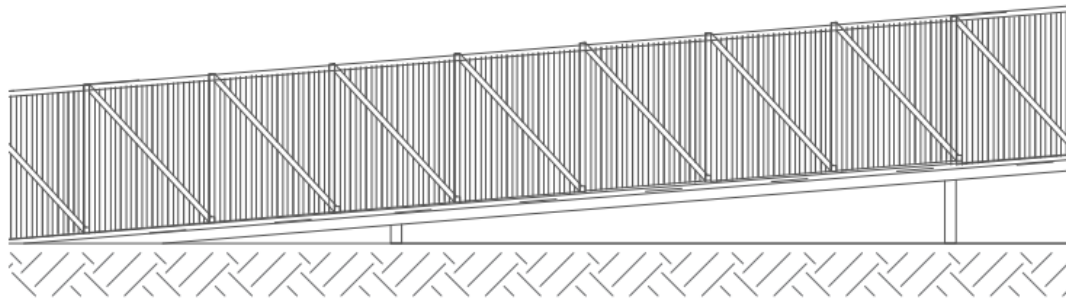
Detallado de Rampa Para Pasarela (AutoCAD)
